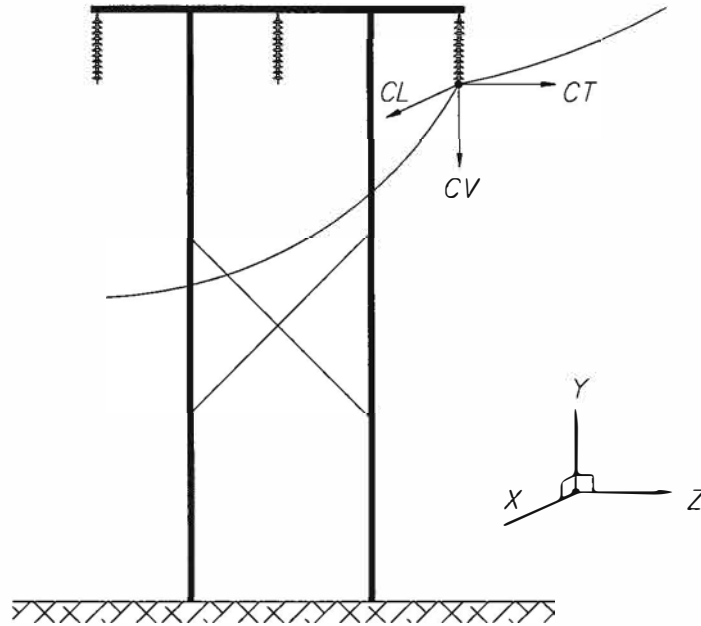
Carga externas aplicadas a la estructura tipo HS
